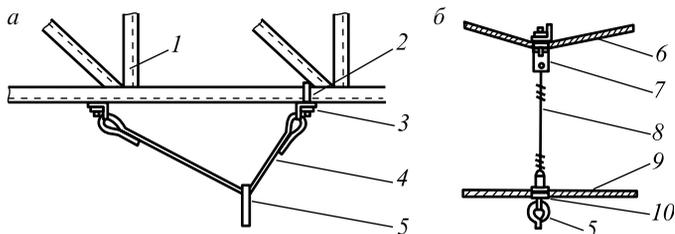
Подвеска на жесткой (*а*) и гибкой (*б*) поперечинах: 1 — жесткая поперечина; 2 — крюковой болт; 3 — опорный уголок; 4 — треугольный подвес; 5 — серьга; 6, 9 — поперечный несущий и верхний фиксирующий тросы; 7 — зажим для поперечных несущих тросов; 8 — струна; 10 — хомутовый зажим
